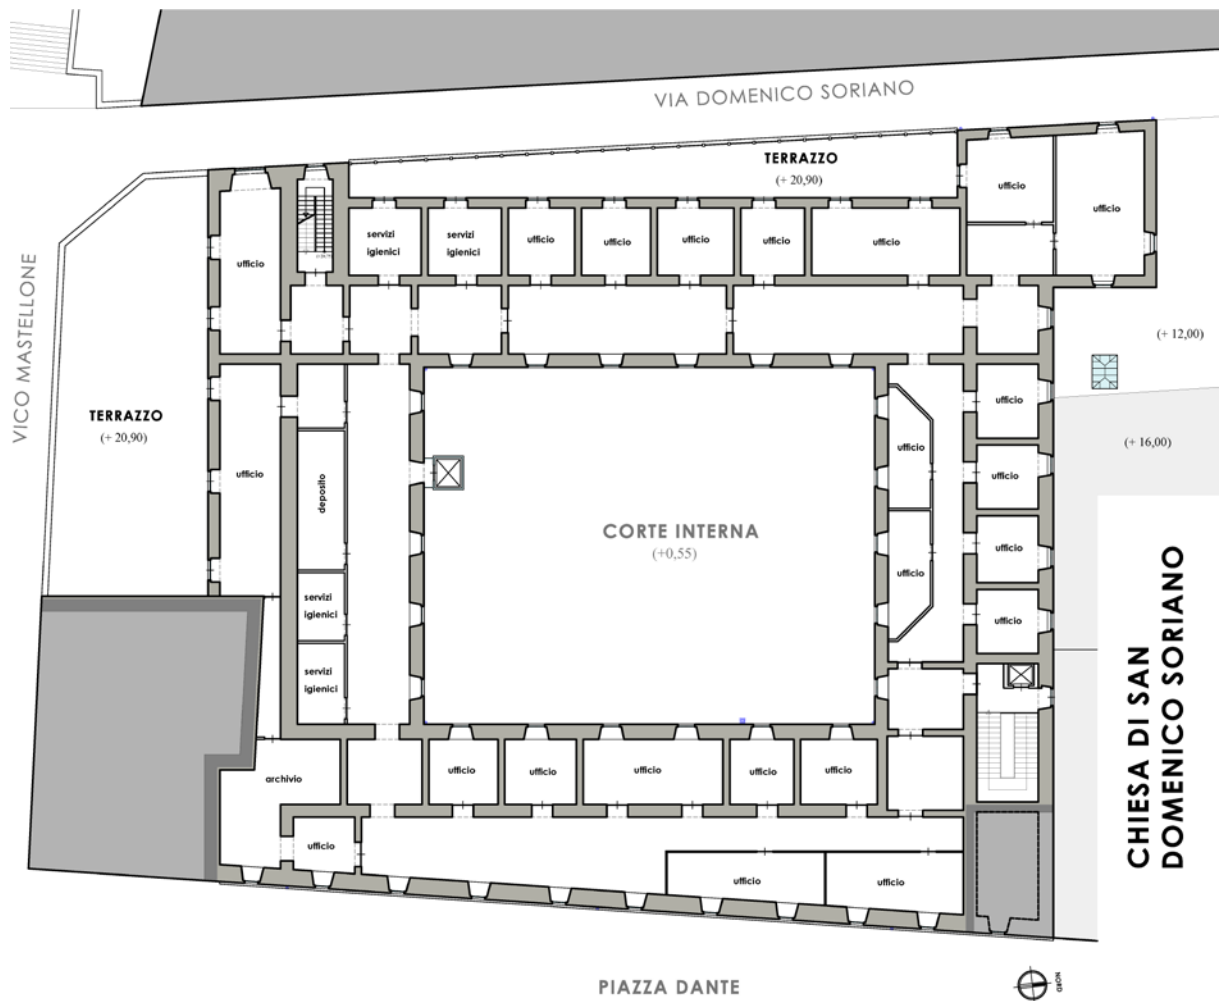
Indicazioni progettuali: Pianta Piano Quarto
